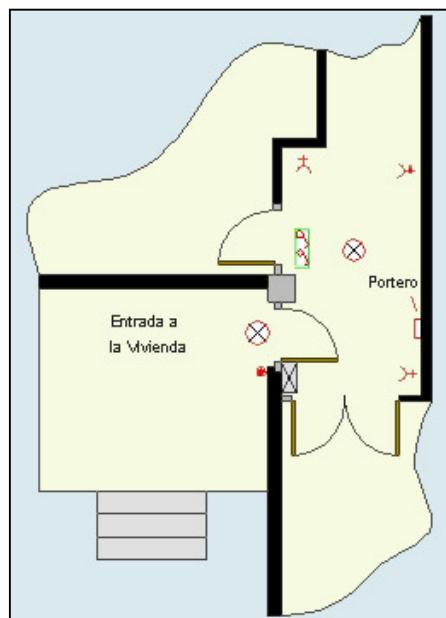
Figura D: Plano de planta del acceso de la vivienda y el vestíbulo
